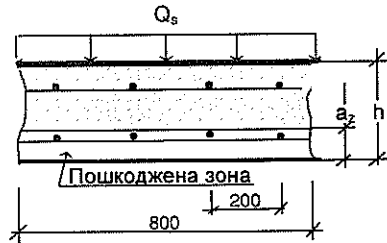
Універсальна розрахункова схема перерізу плити перекриття у перерізі між опорами та у перерізі над опорами.
